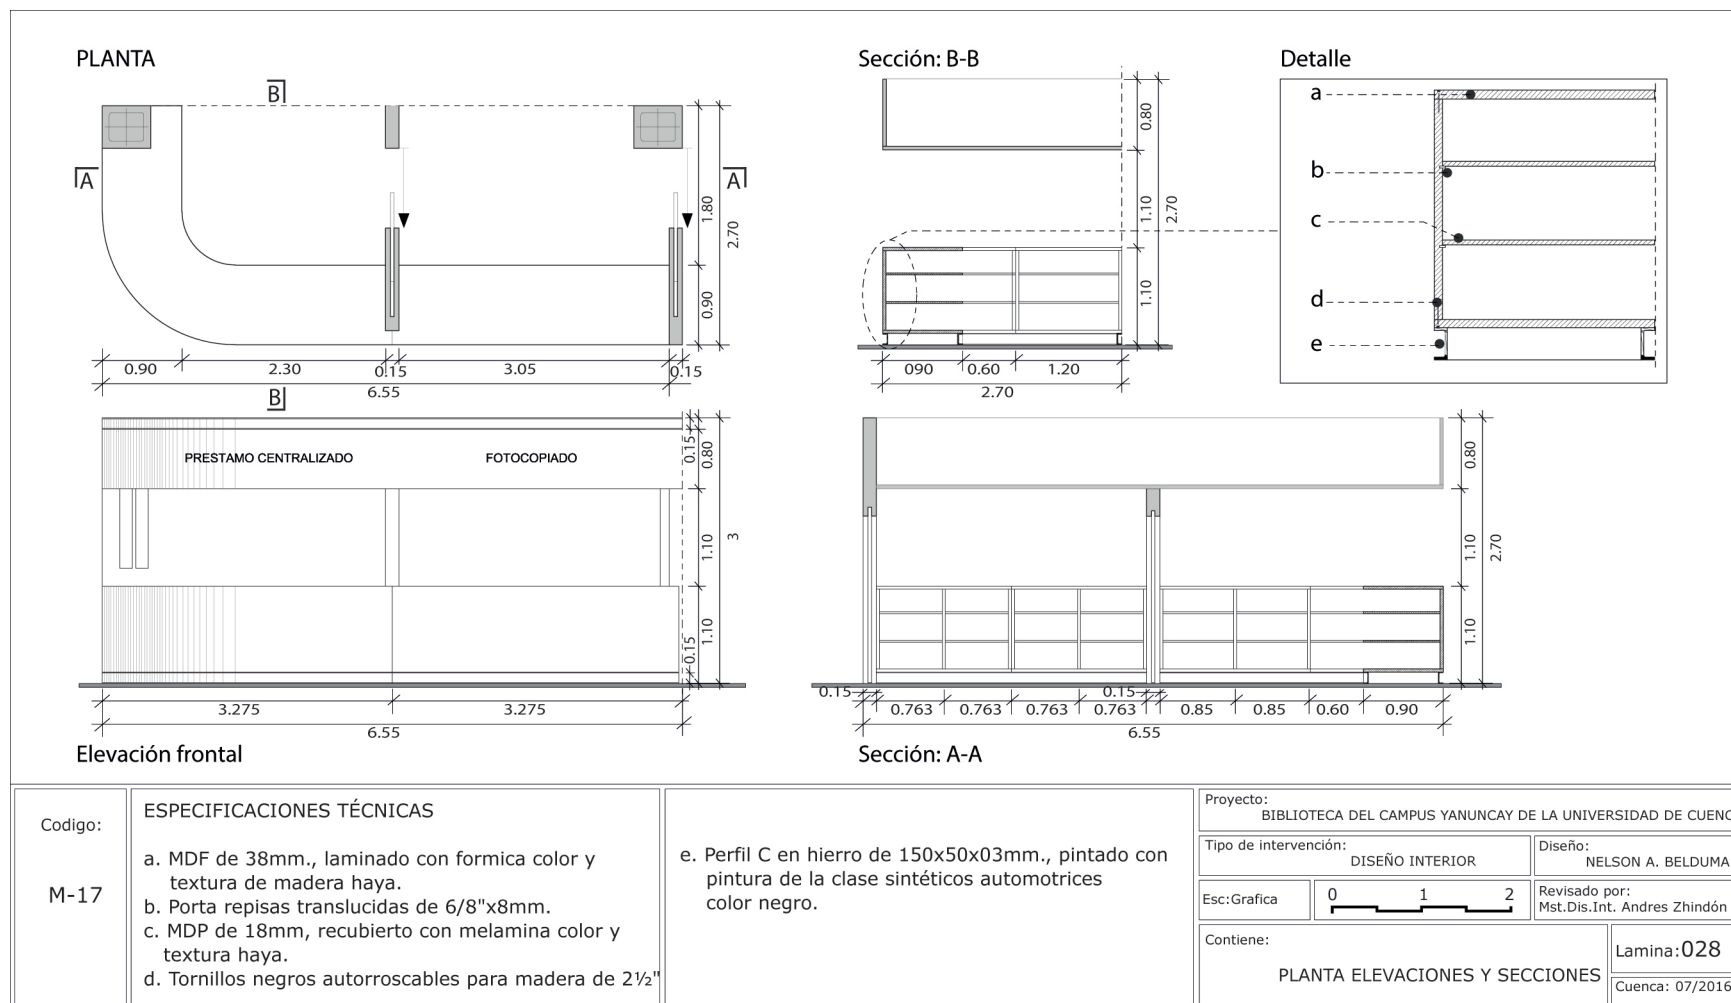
Planta, elevaciones y secciones. Counter de préstamo y fotocopiado. M-17.
